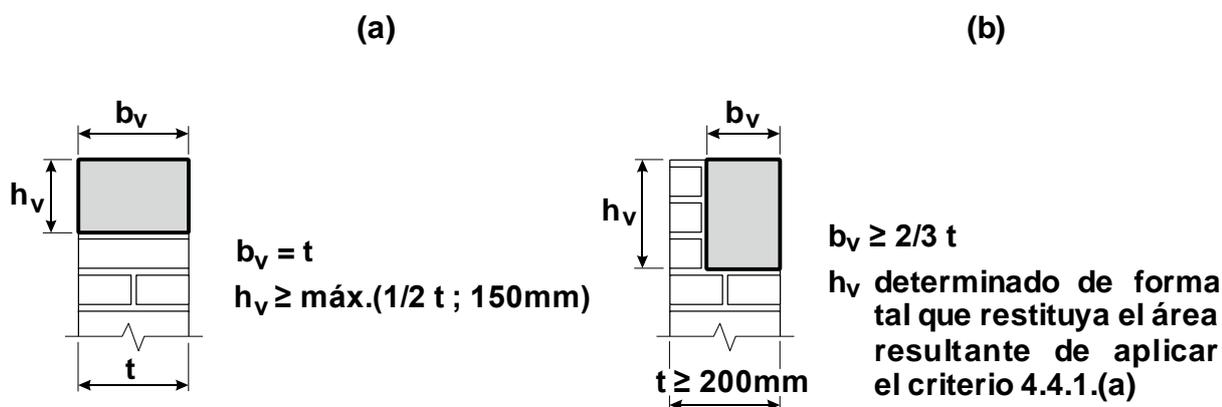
Sección transversal de vigas de encadenado de hormigón armado.
